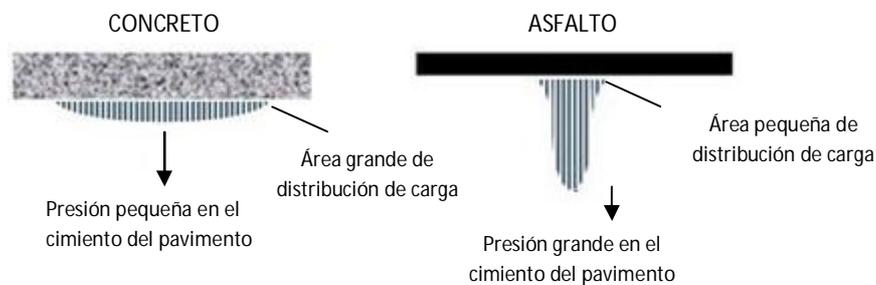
Esquema de comportamiento de un pavimento flexible y rígido.
